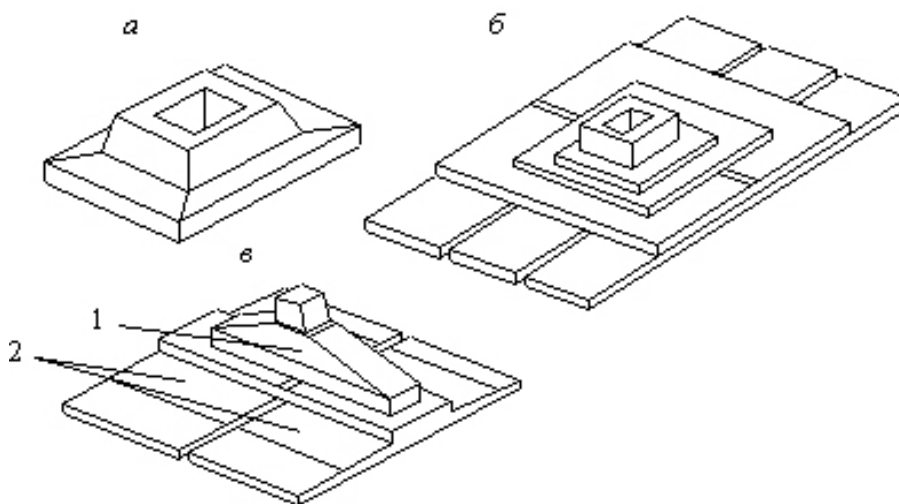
Сборные железобетонные фундаменты под колонну:
